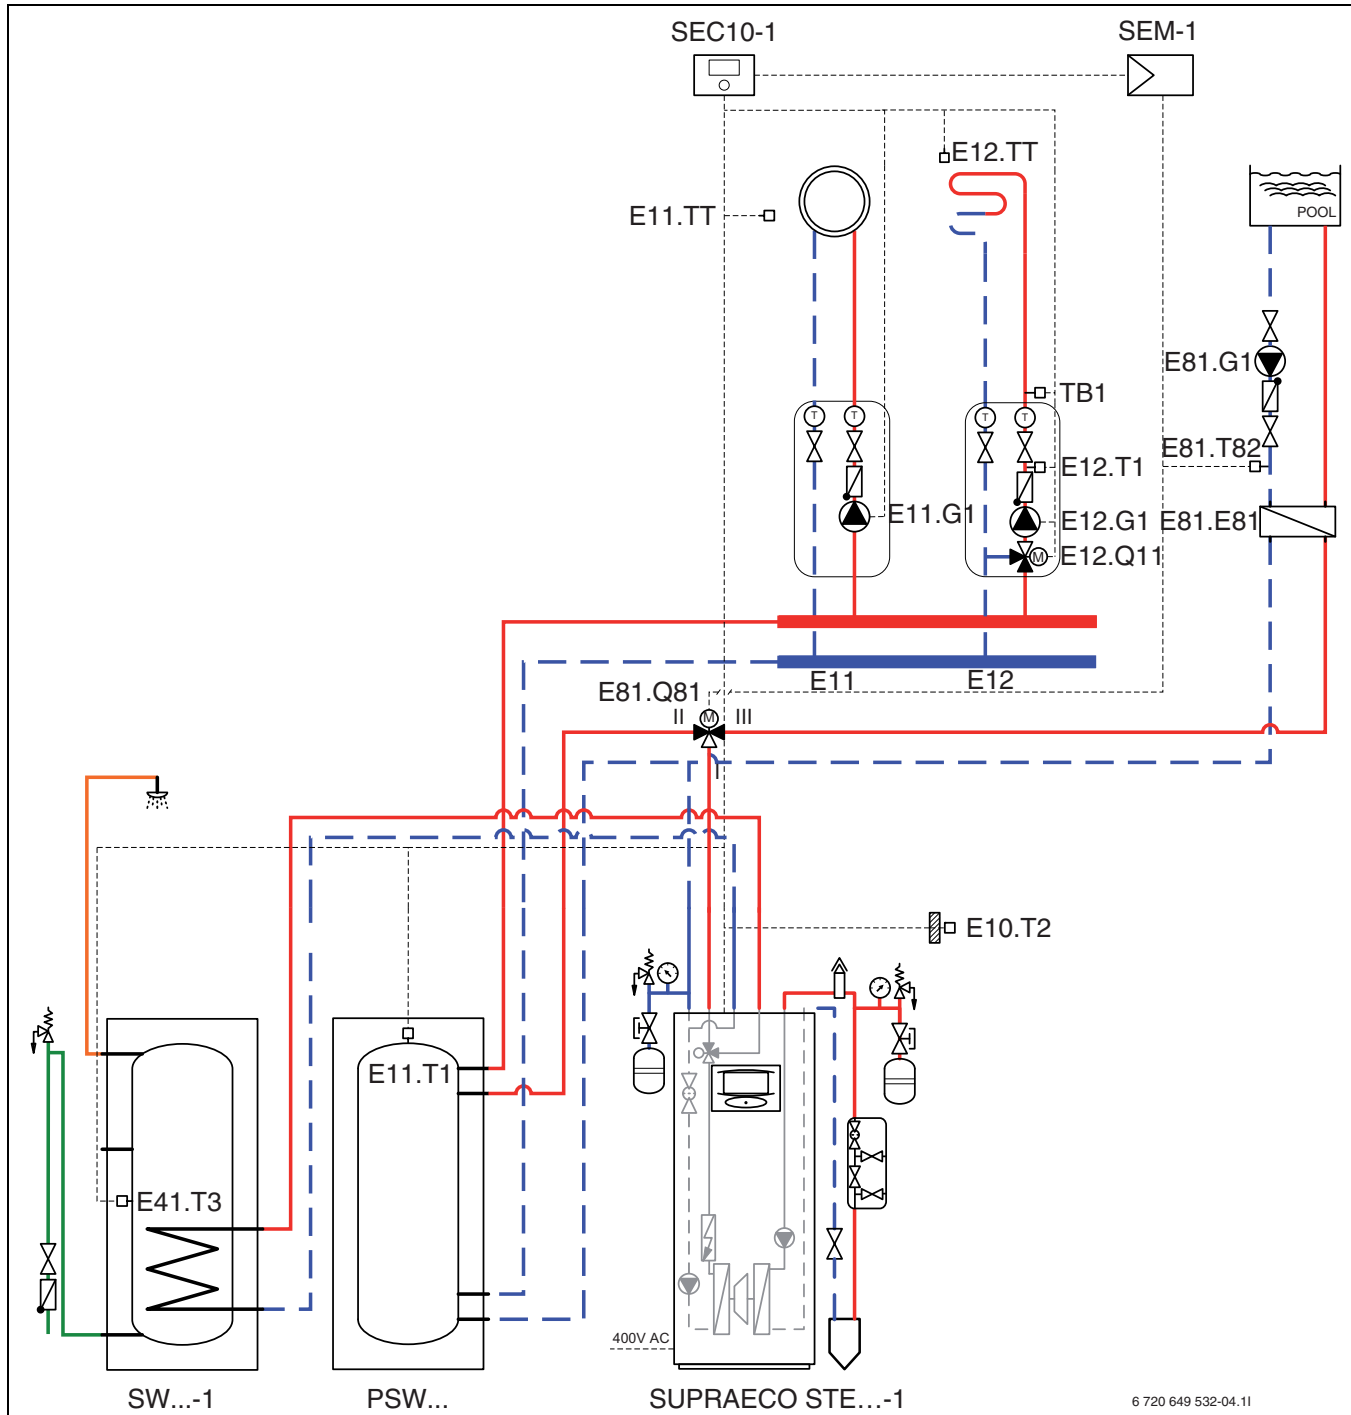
Ungemischter und gemischter Heizkreis mit Pufferspeicher, Multimodul und Schwimmbadsteuerung
